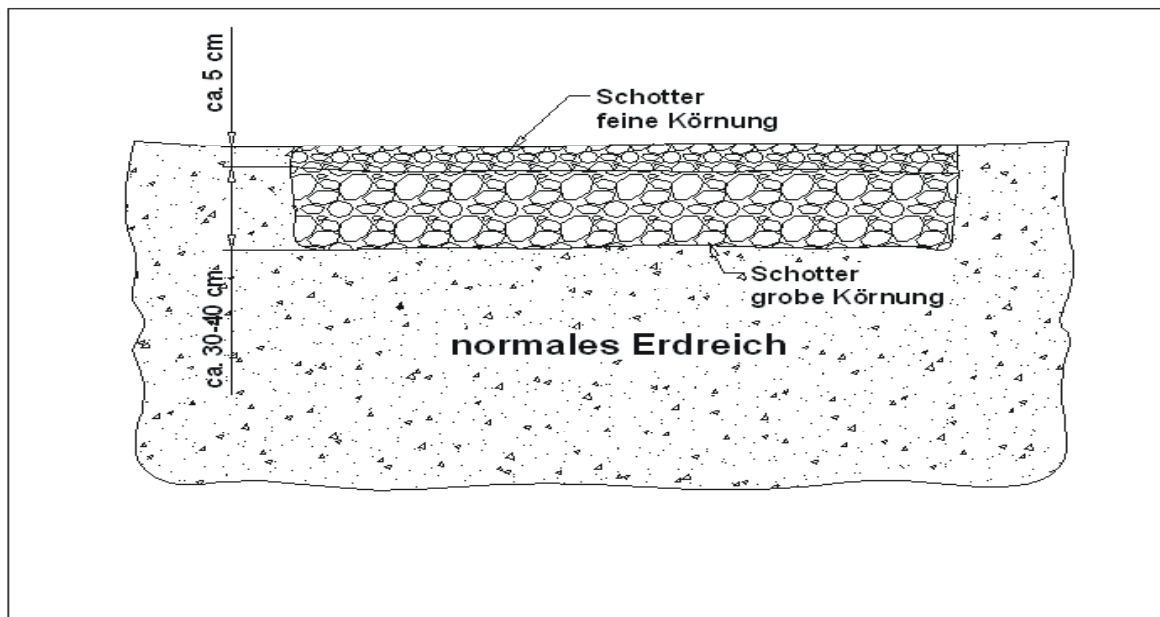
Ausschachtung mit Aufbau Untergrund als Schotterbett
